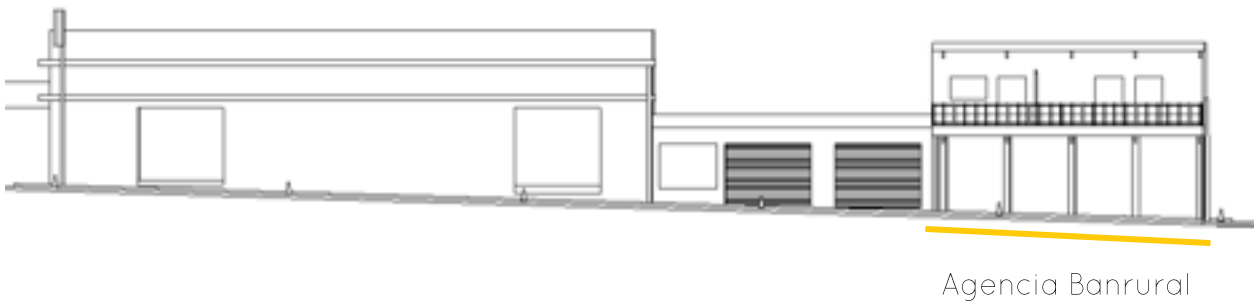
Extracción de formas 1ra avenida entre 2da y 3ra calle fachada Este
